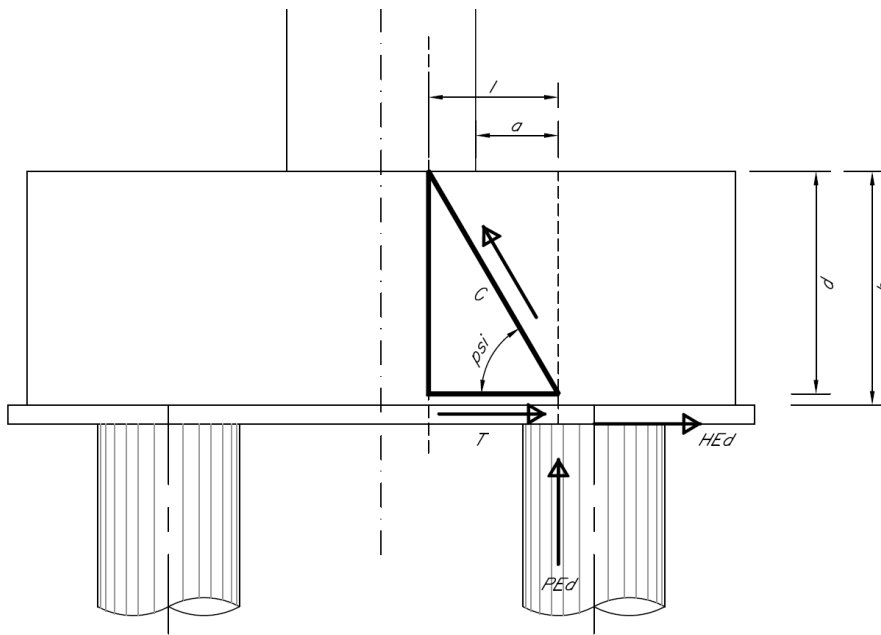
Vista in sezione - Tirante-puntone – Biella compressa di calcestruzzo e tirante di armatura
